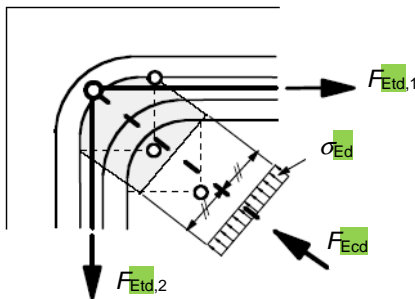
Druck-Zug-Knoten mit Bewehrung in zwei Richtungen
